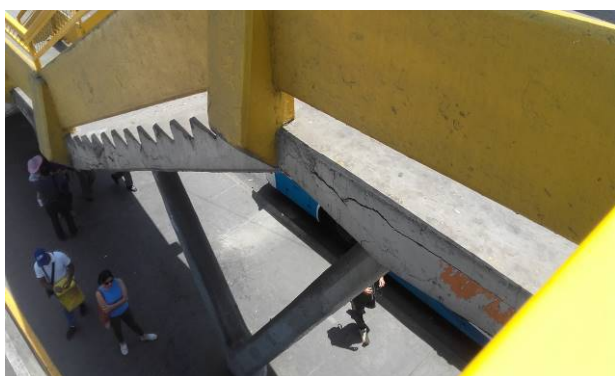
Fisuras en las escaleras de acceso al puente peatonal Porvenir.
